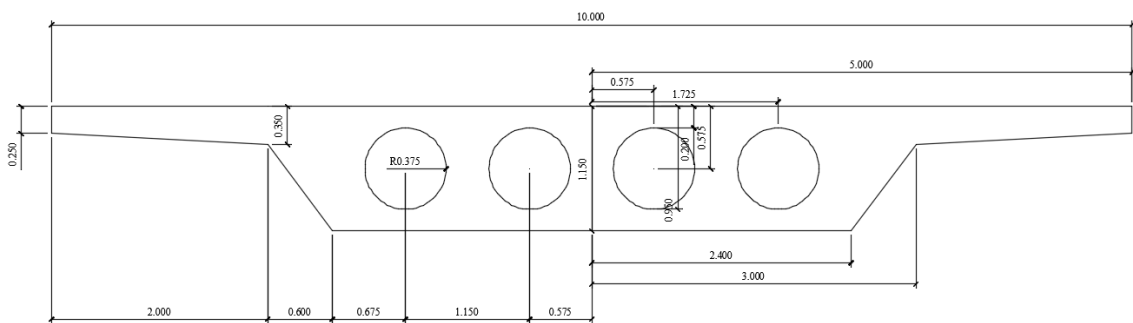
Ejemplo. Sección transversal de la pieza aligerada de hormigón pretensado.
